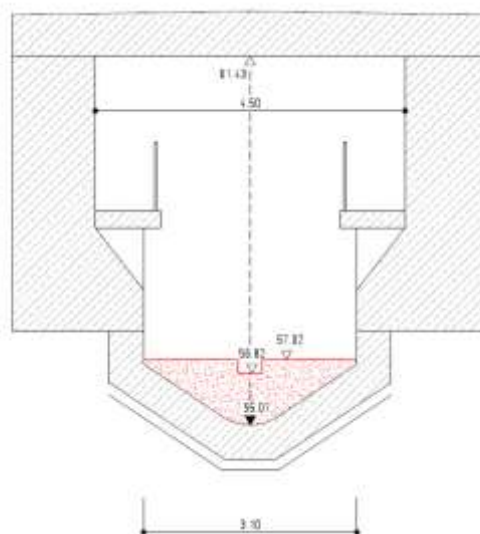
Anpassung der Sohle Brückenbauwerk Verbandsstraße WS
